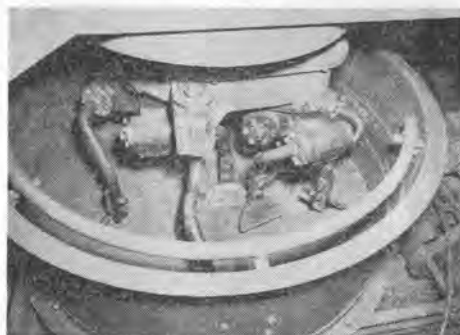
強制練りコンクリートミキサ (プラネタリー式)
